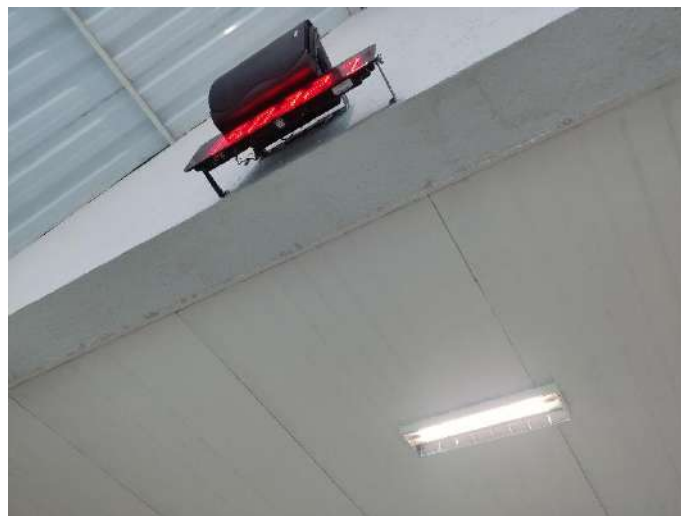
Infiltração (gotejamento) no hall/galeria dos gabinetes parlamentares.
